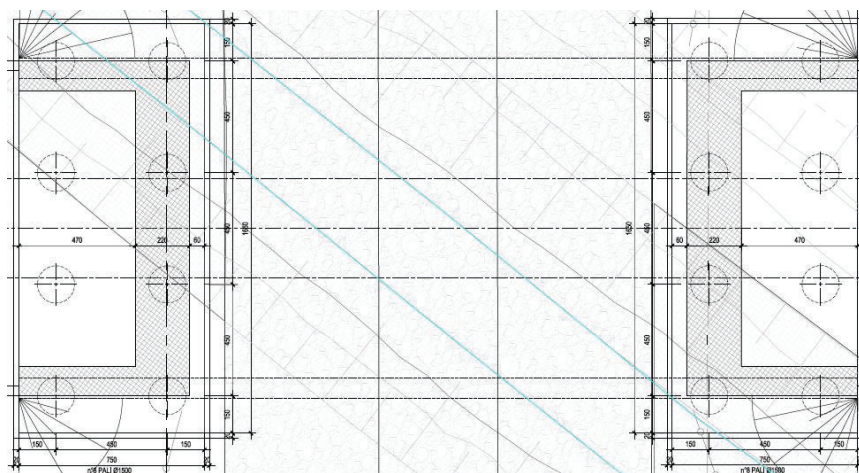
Pianta delle fondazioni delle pile e delle spalle
